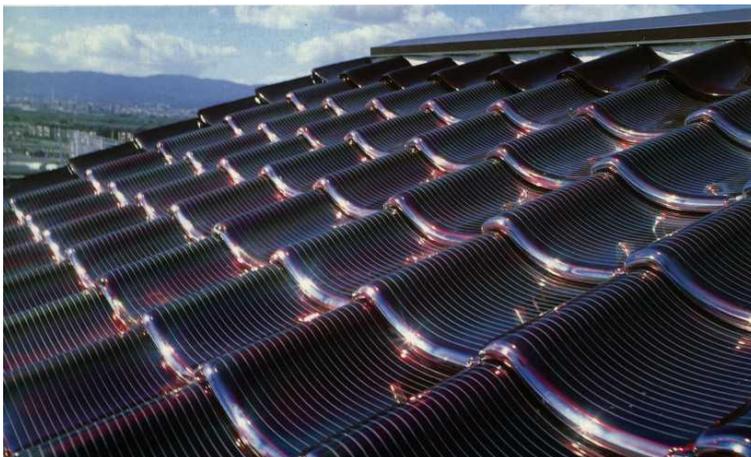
Painel solar fabricado diretamente nas telhas de vidro. Fonte: Rütther (1999)
